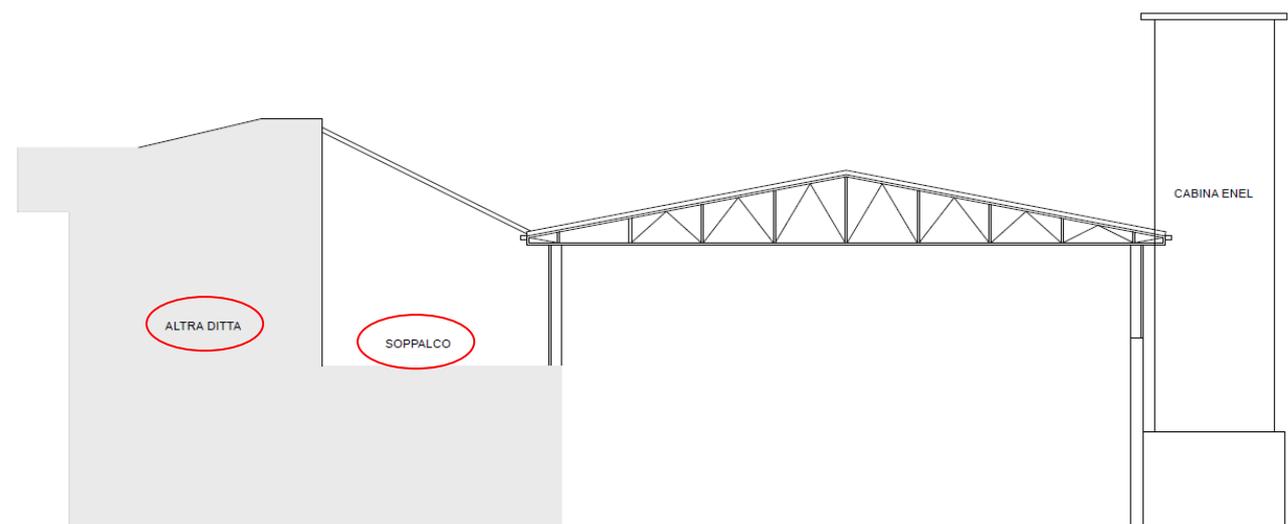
Planimetria sezione dell'edificio: “soppalco” e parte sottostante di altra proprietà.
